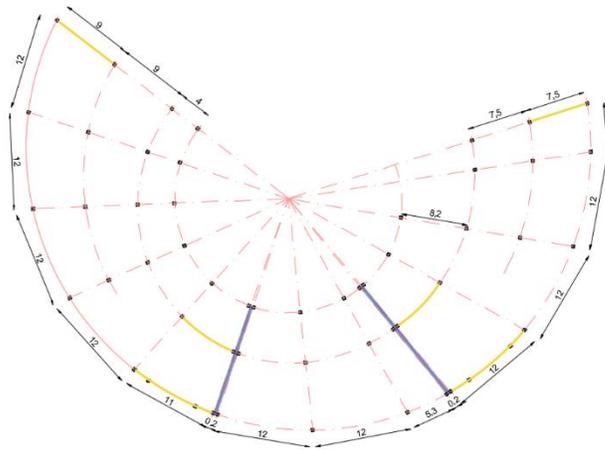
la proposition de la trame structurelle. Source : auteur,2023
